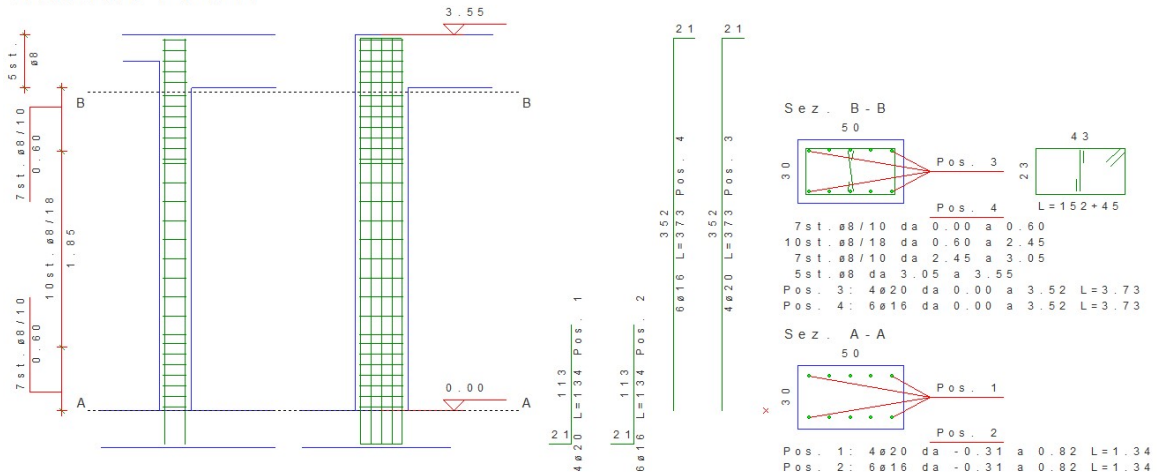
PILASTRO N. 1, 6, 7, 12
